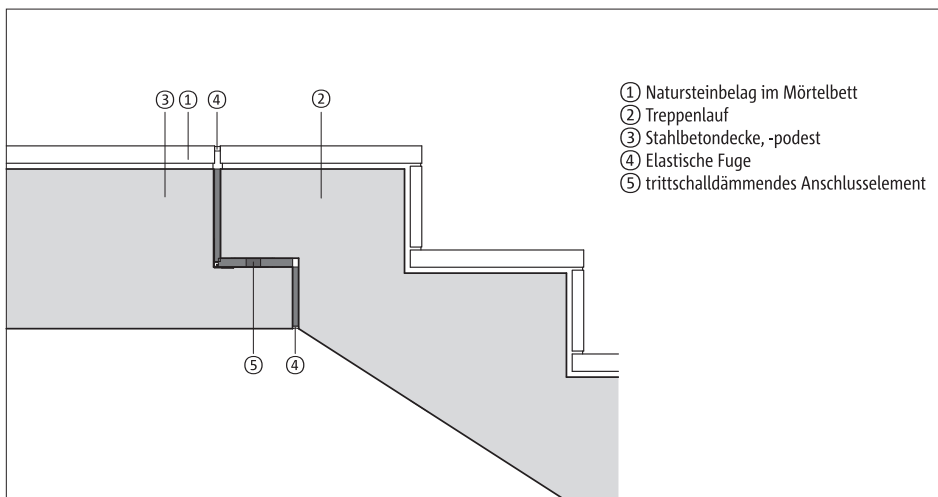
Beispielhaftes Anschlussdetail – Treppenlauf an Podest/Geschossdecke mit Betonkonsole
